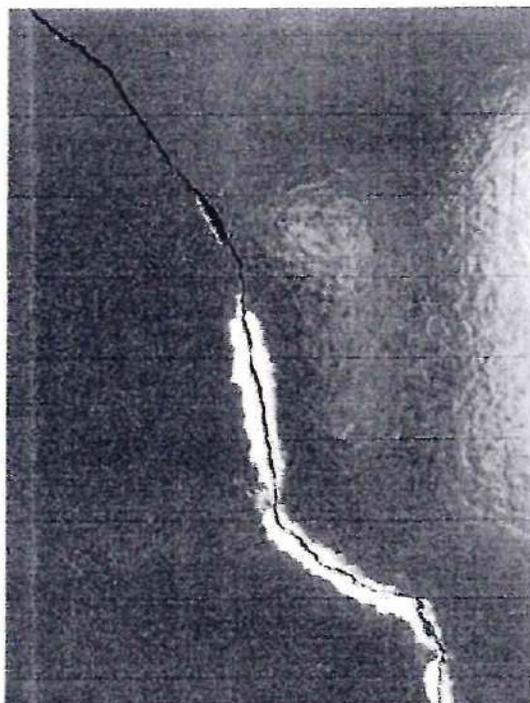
COMEDOR 2° PISO (FISURA EN FOTO 2 EN DETALLE)
